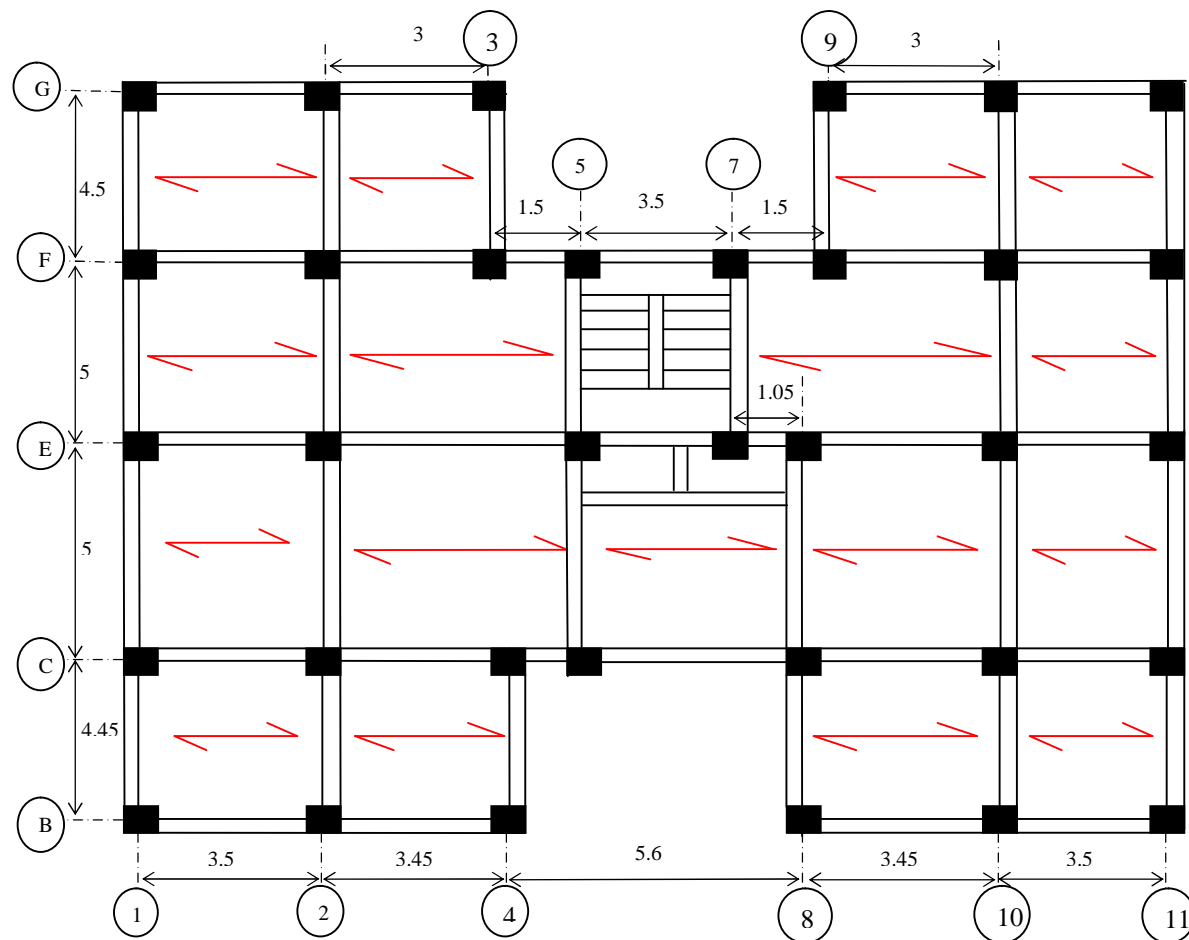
Sens de disposition des poutrelles du 6^{eme} au 8^{eme} étage.
